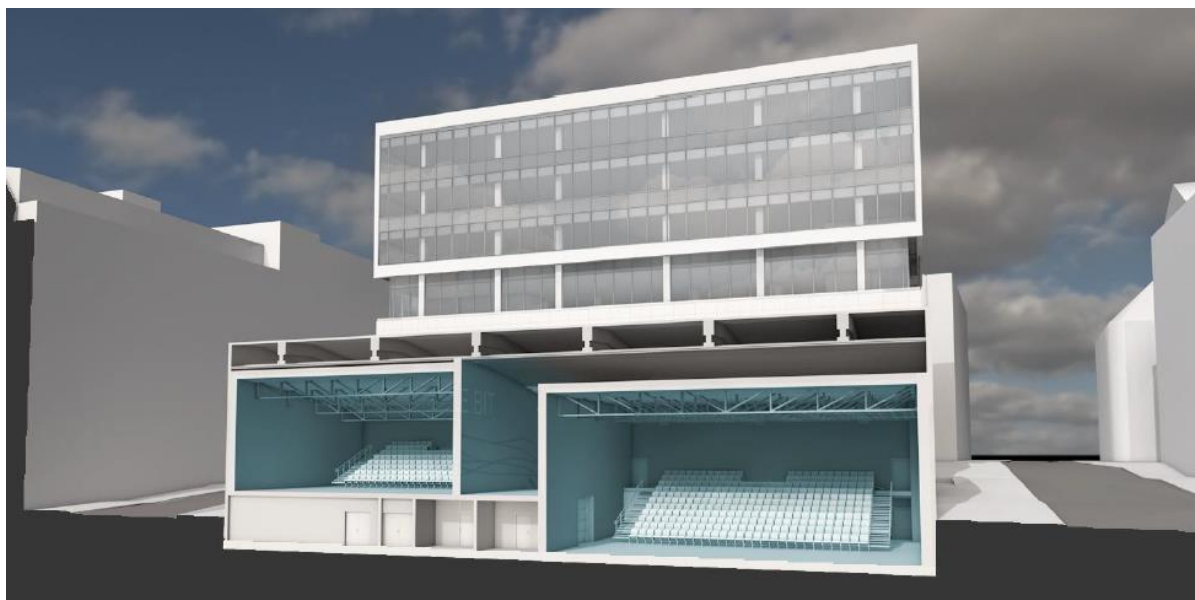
Snitt gjennom CB studio i plan 0 og prøvestudio i plan 3.
